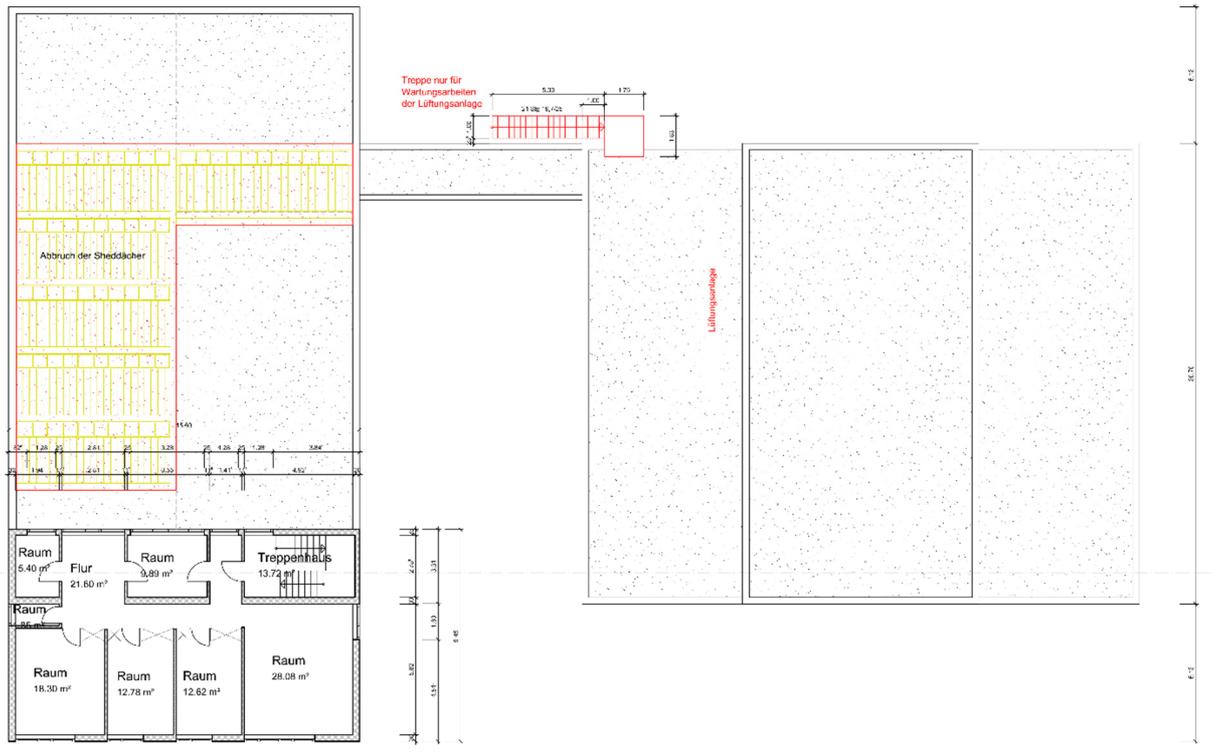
Kulturpark Grundriss Obergeschoss
